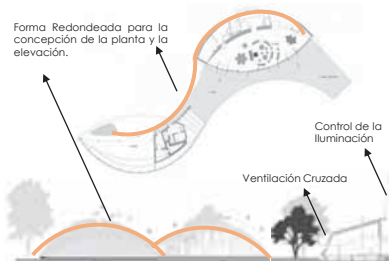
Planos de Planta y Corte Centro Ecoturístico.
